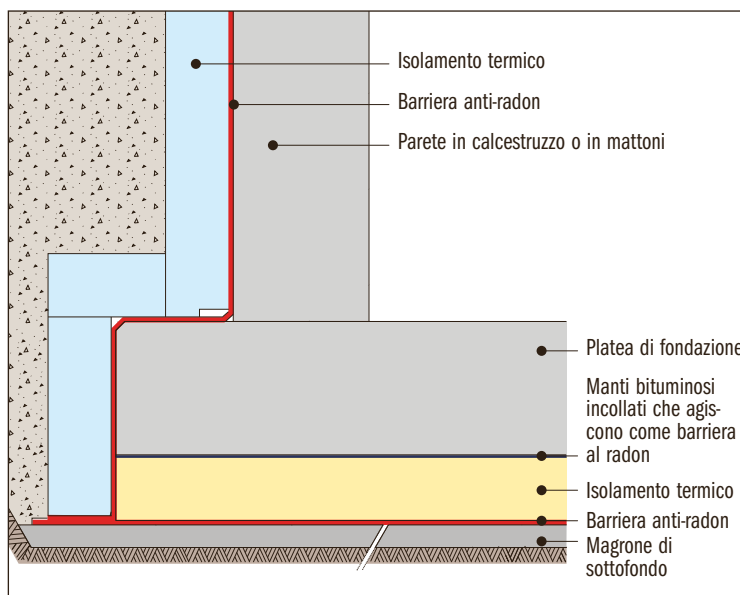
Nuova costruzione con isolamento perimetrale e platea di fondazione con scantinato (Fonte: Dow Building Solutions).
